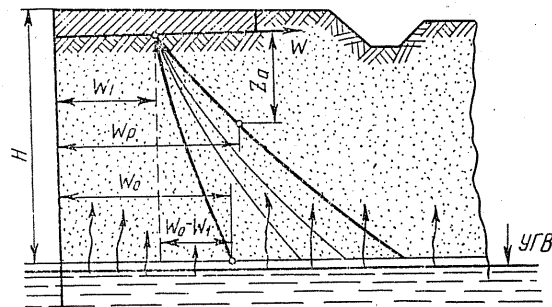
Схема к расчету возвышения бровки полотна над уровнем грунтовых вод (по В. М. Сиденко)
